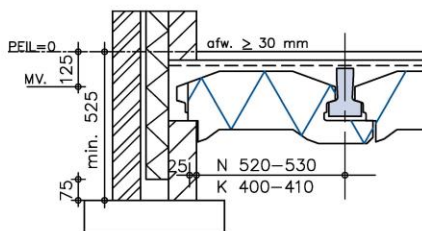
DETAIL - EINDOPLEGGING ZONDER RANDKIST
